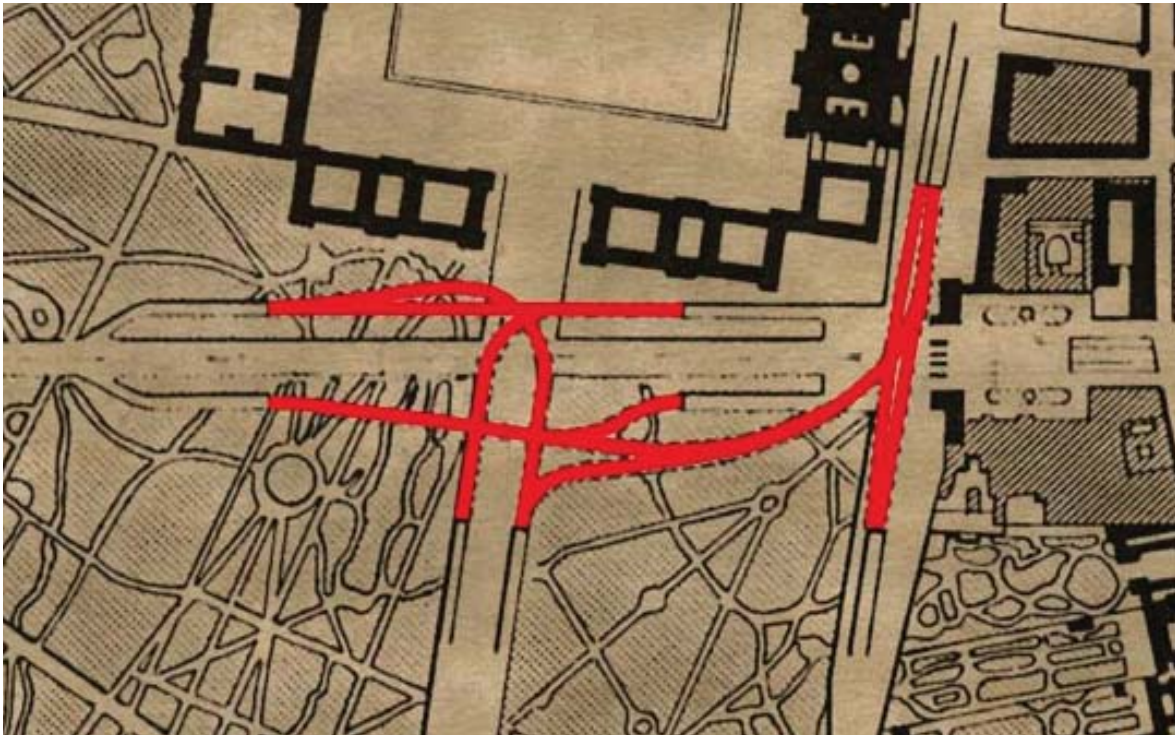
Plan de situation général de l'ouvrage souterrain.
